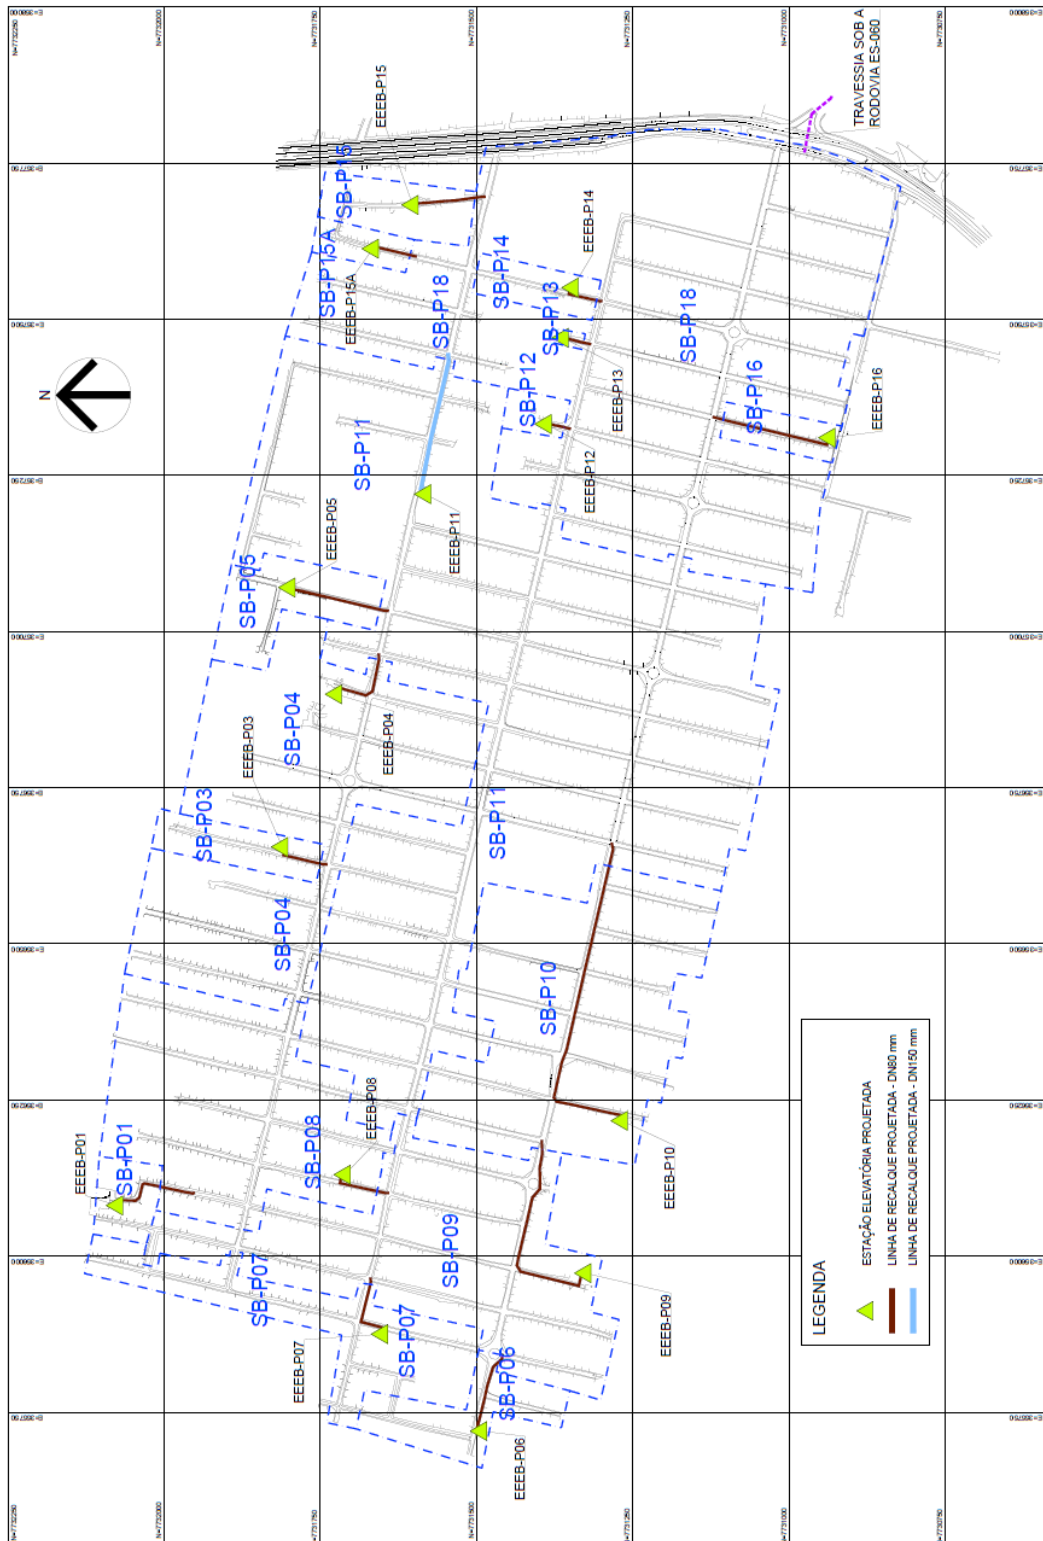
Planta geral do sistema de Balneário Ponta da Fruta.
